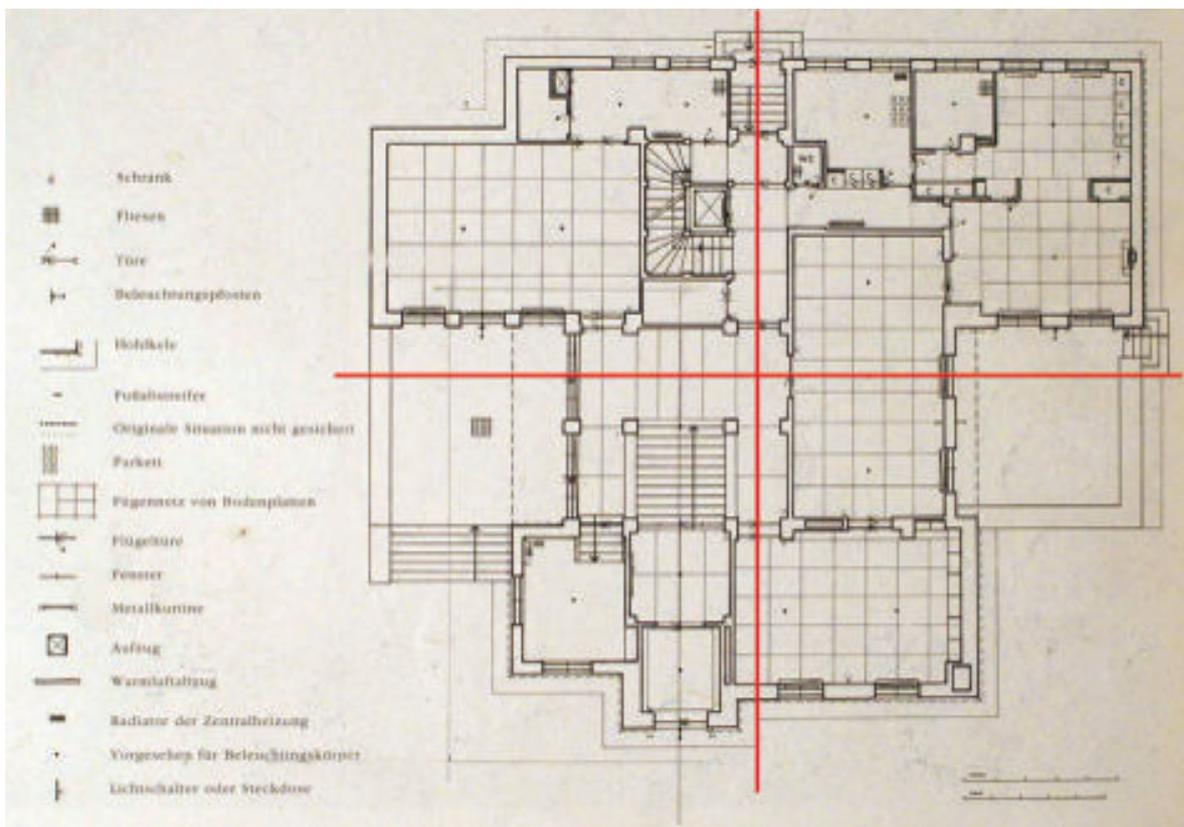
Grundriss, Erdgeschoss von Villa Stonborough¹⁰⁹
